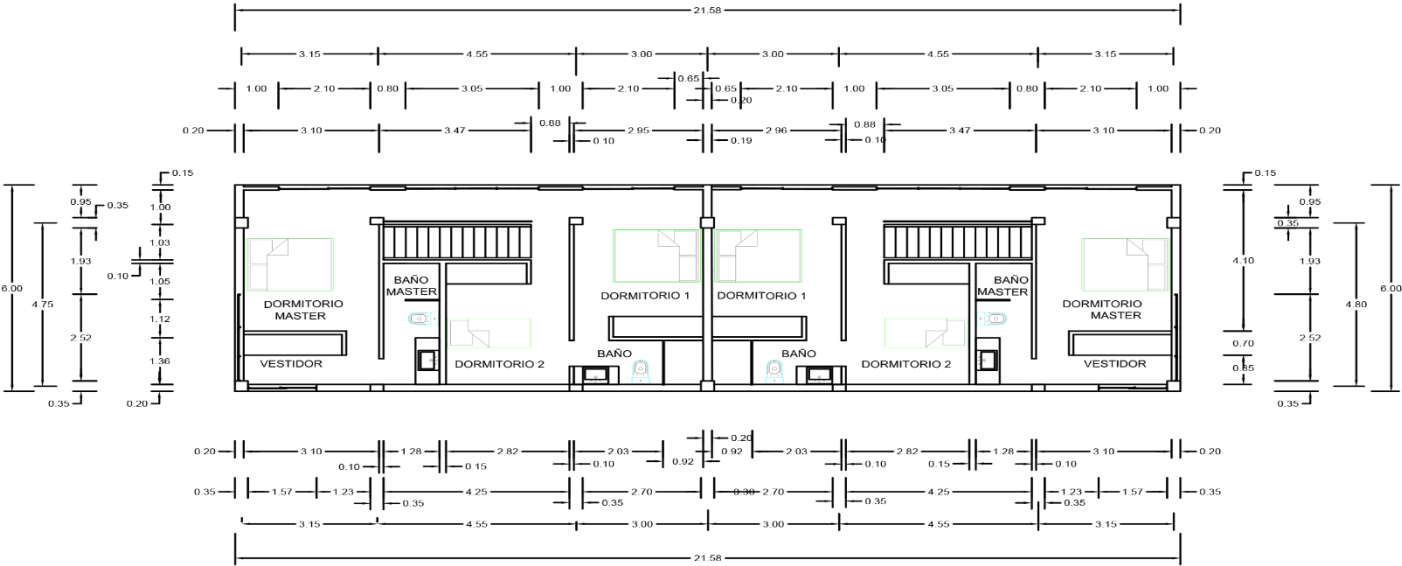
Detalle de planos arquitectónicos - planta baja – Fuente: Carpio (2017)
